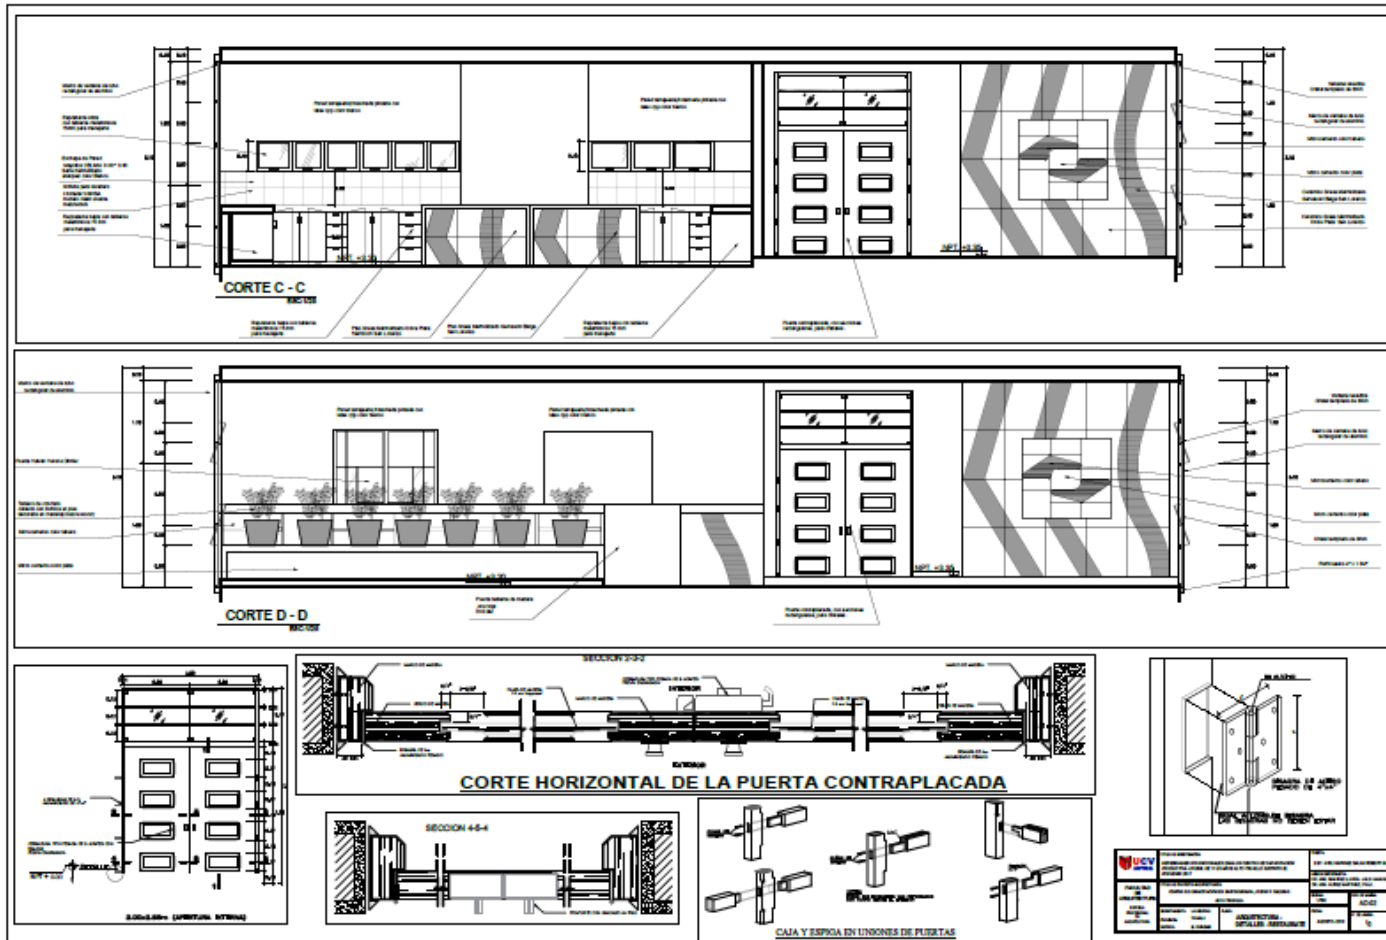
Plano de Detalle Arquitectónico, cortes y detalle de cerrajería de vanos de restaurante -Plano N°10-Lámina AD02
